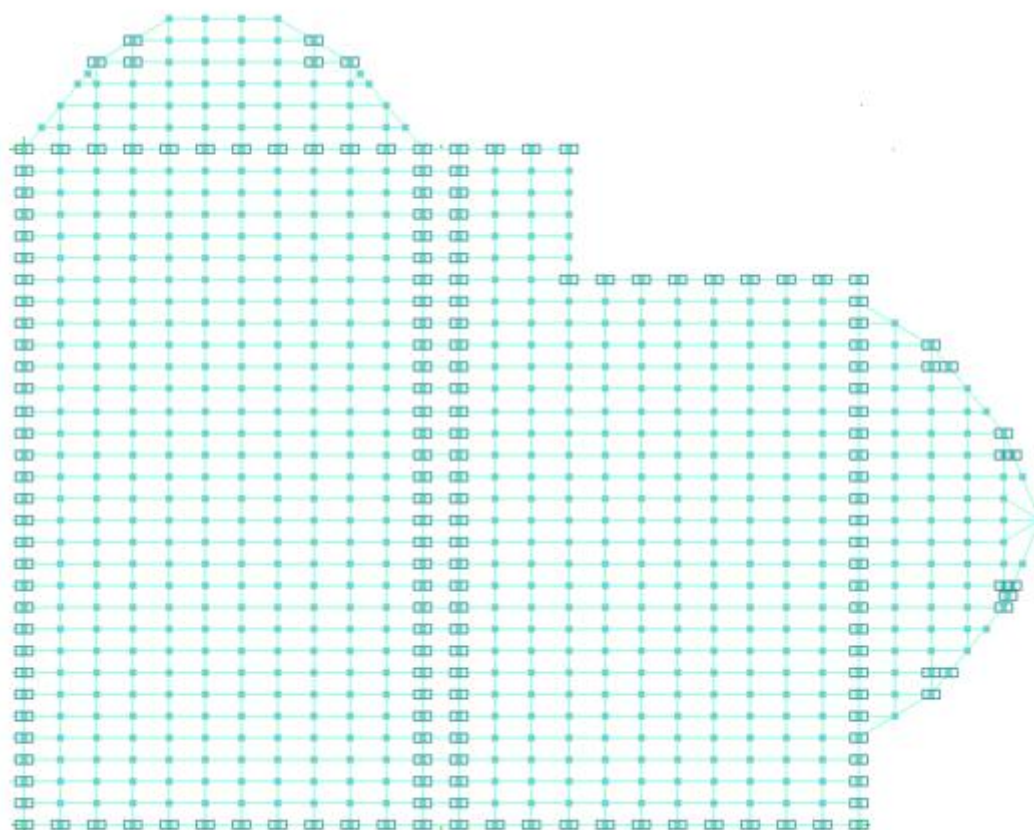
Расчетная схема плиты перекрытия в плоскости:
